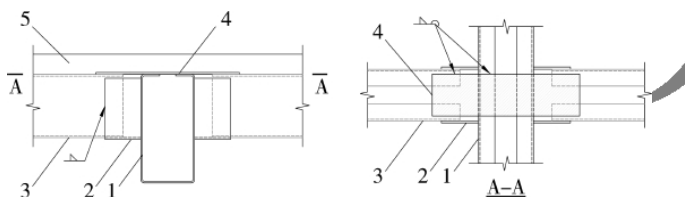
外包钢组合梁的主次梁盖板连接节点构造
